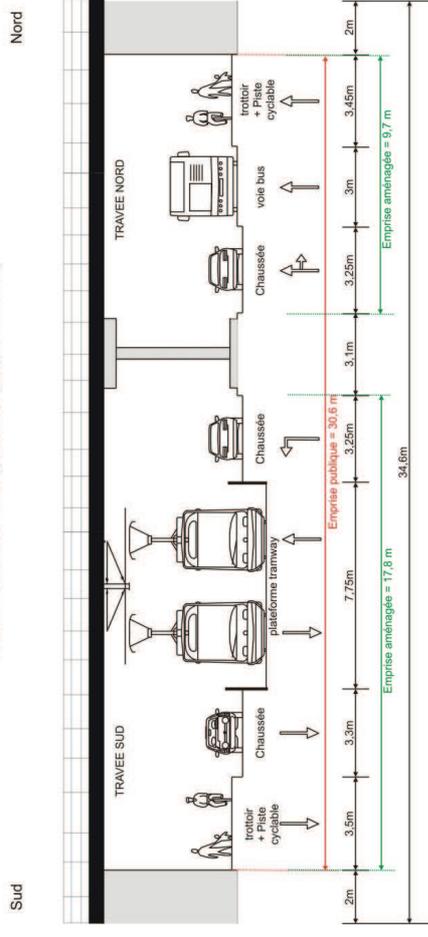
Aménagement projeté (variante) – coupe 33 – sur la rue de Koenigshoffen (pont 3)
